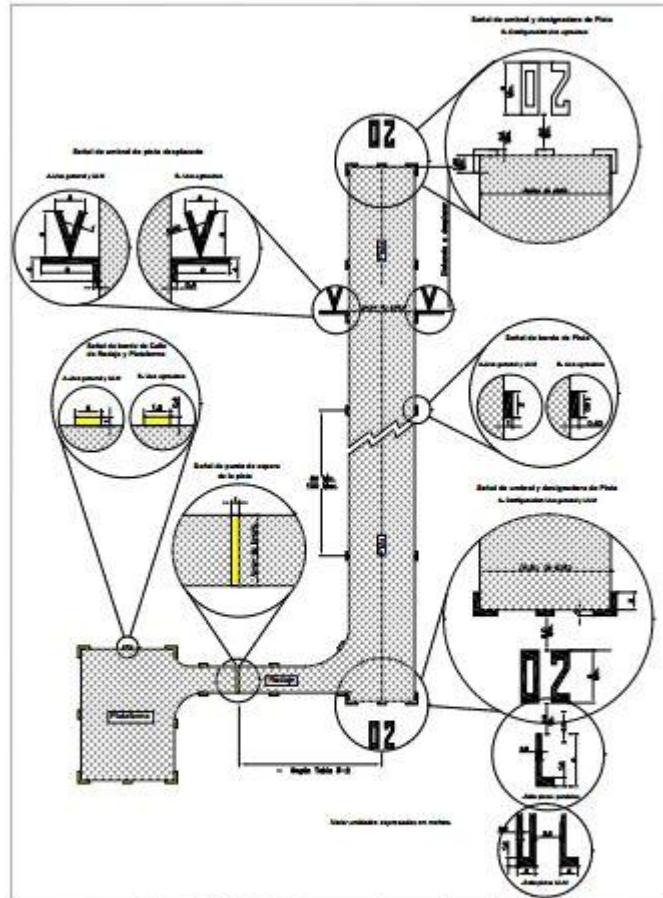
Señalamiento diurno para pistas no pavimentadas
